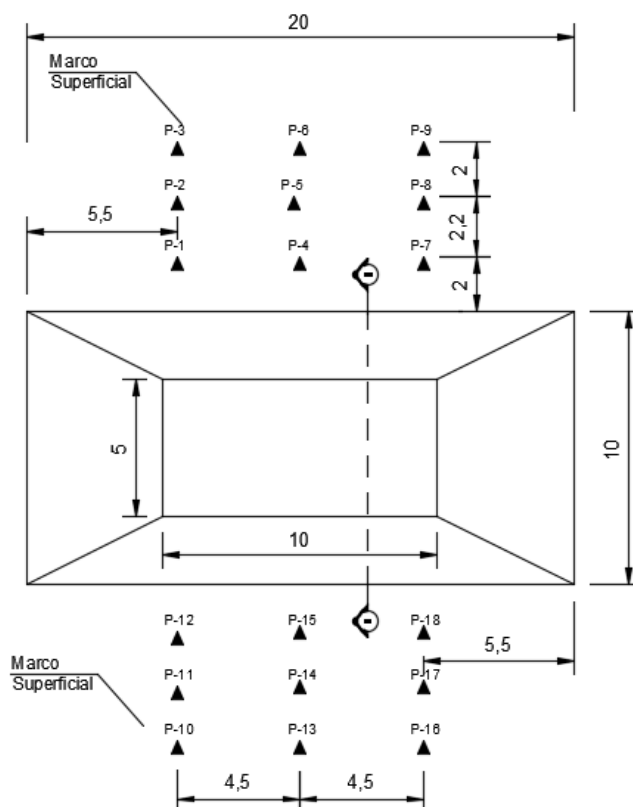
Planta do ensaio de carga e localização dos marcos superficiais
